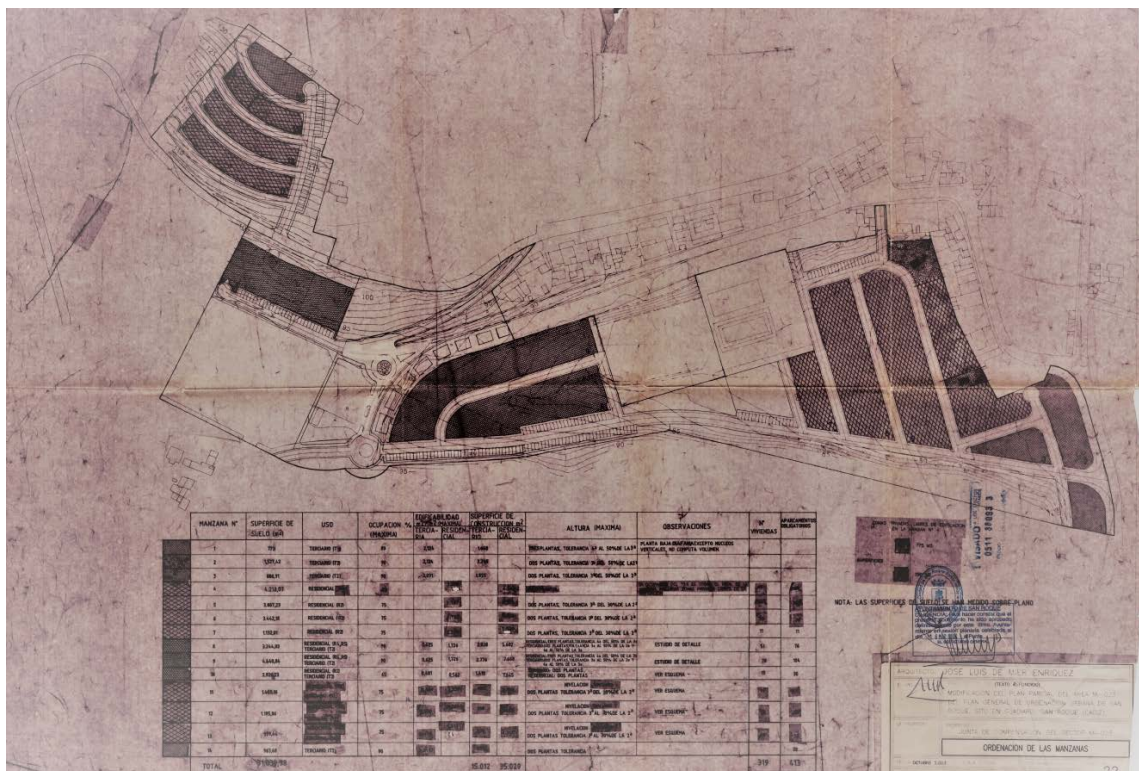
MODIFICACION DE PLAN PARCIAL DE AREA MI-23 .PLANO 22 ORDENACION DE MANZANAS.16/03/2004
